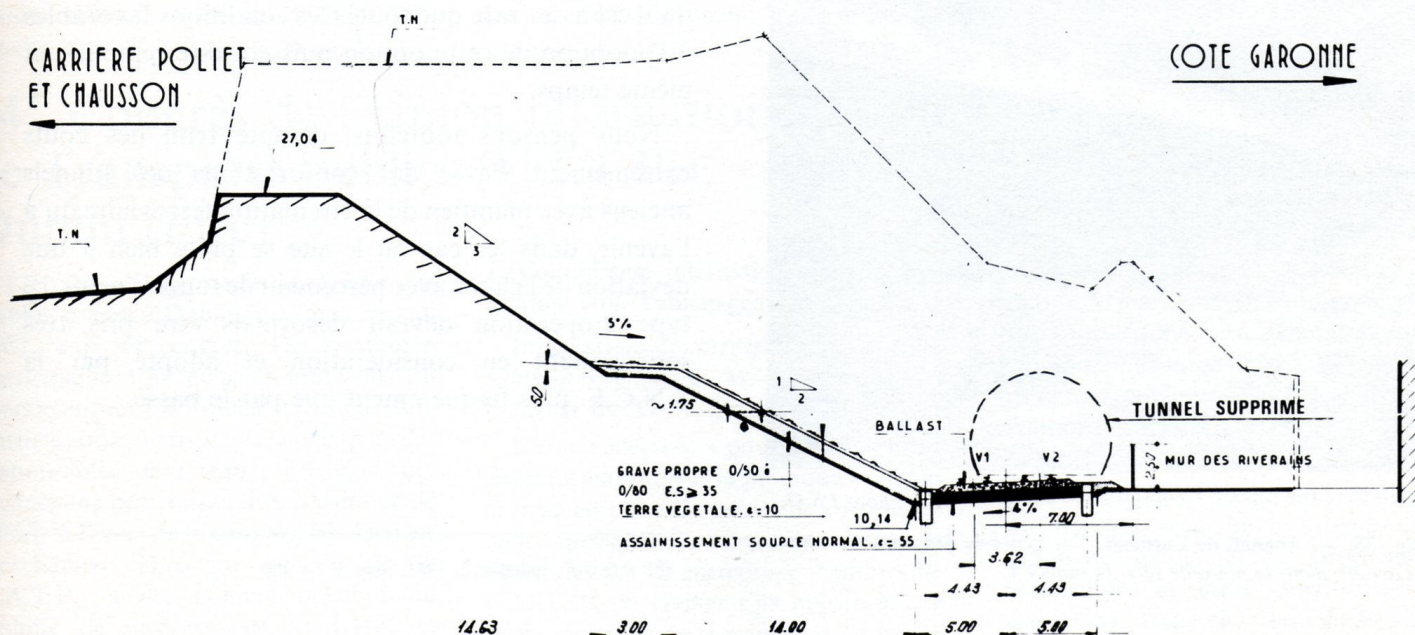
Tunnels de Lormont. Démolition du tunnel 5.
